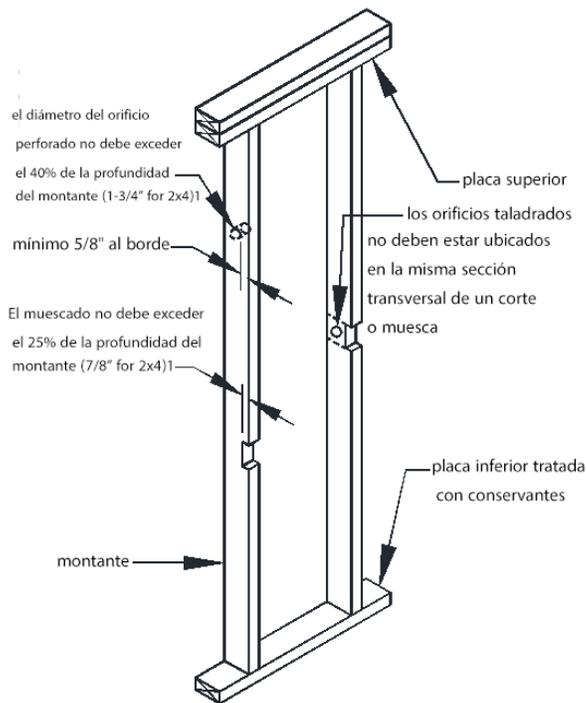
PERFORACIÓN Y MUESCADO DE VIGAS
